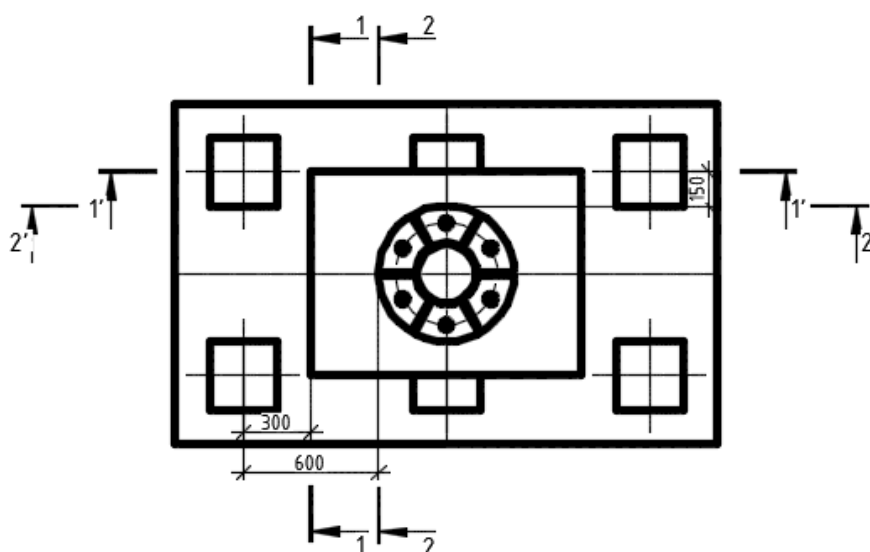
Схема расчета плиты ростверка на изгиб
